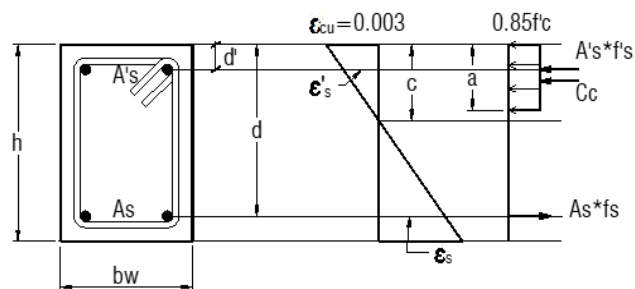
Sección de viga con diagrama de Esf. y Deformación
